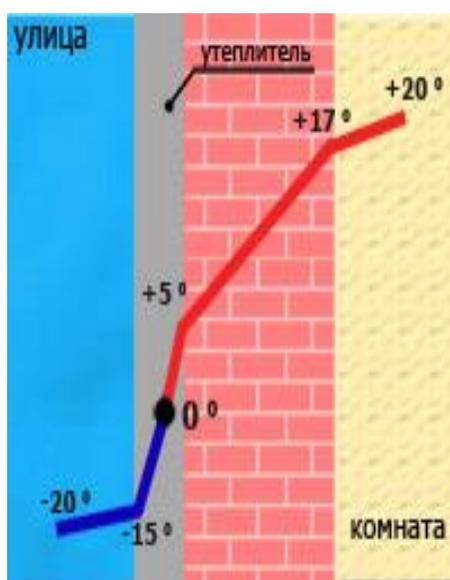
Утепление стен выполнено снаружи помещения
